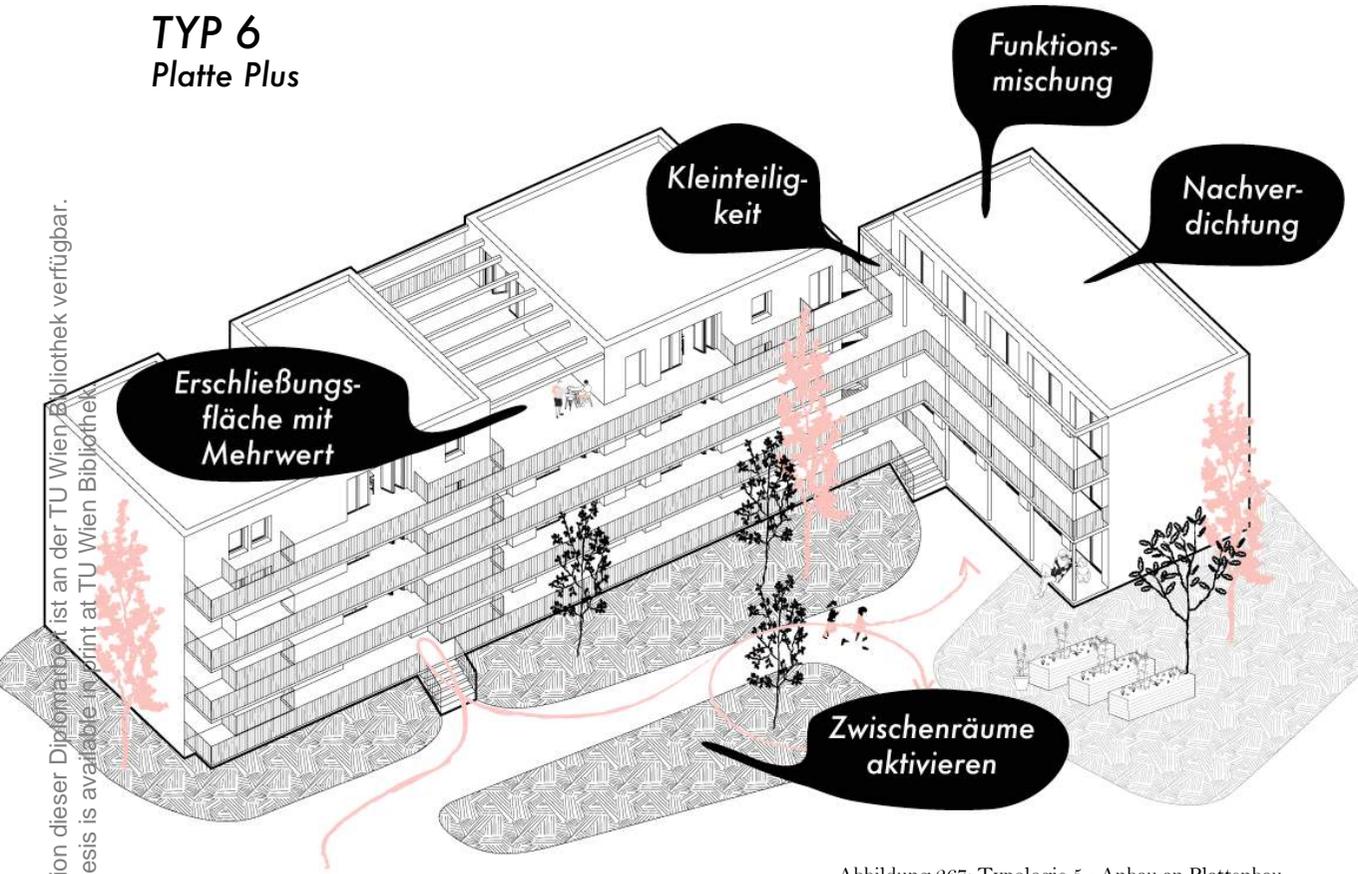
Typologie 5 - Anbau an Plattenbau
